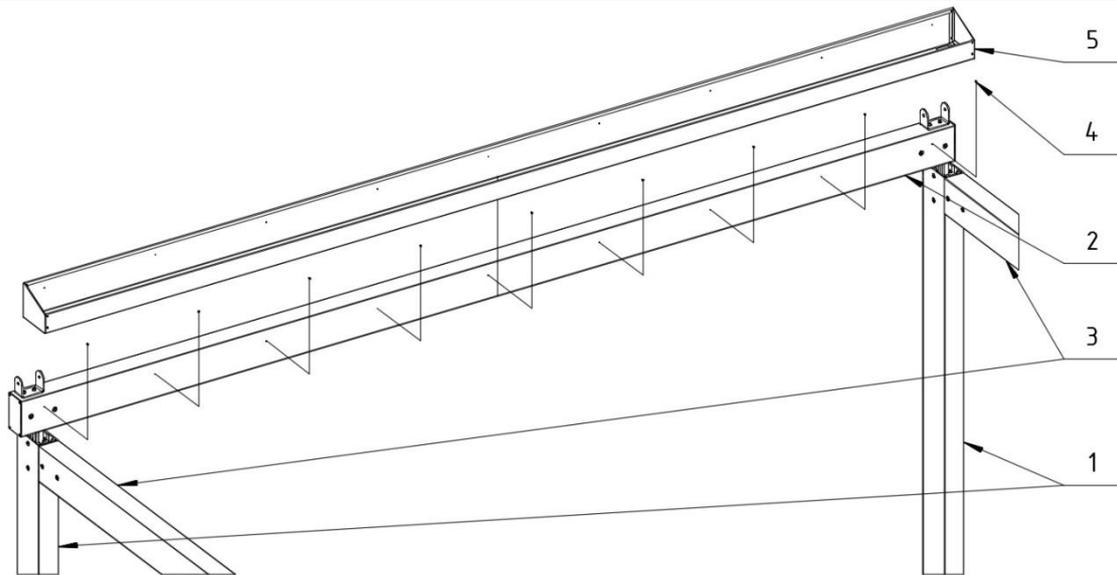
Méthode d'installation de la gouttière : 1 - Poteau bas, 2 - Poutre avant, 3 Poutre latérale (en option), 4 - Vis autoperceuses St 2,9x6,5, 5 - Gouttière.
